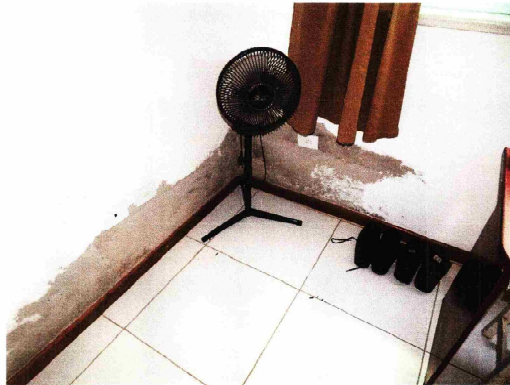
VISTA INTERNA QUARTO II – ACESSO AO BANHEIRO APTO.
